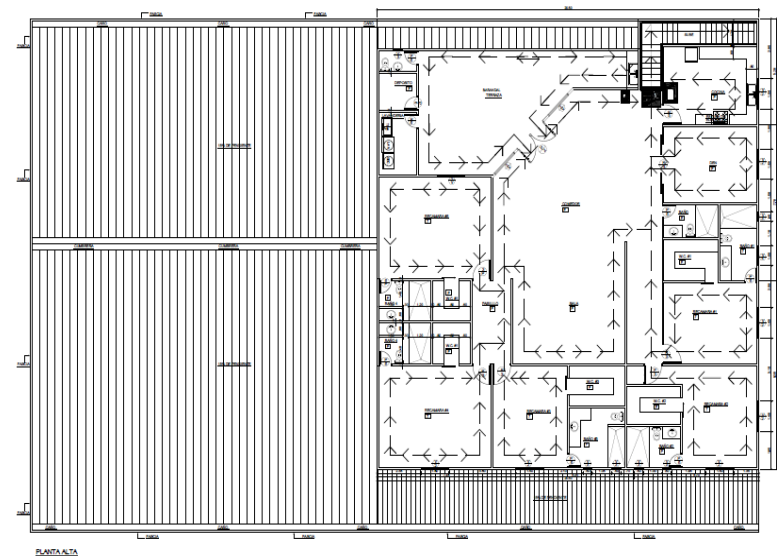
Segunda planta del proyecto (Nivel 001)
